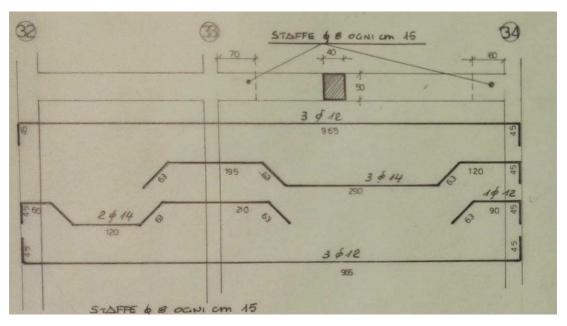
Stralcio del progetto esecutivo reperito Padiglione n.16. – Particolari armature trave 32-34 I impalcato Zona B
